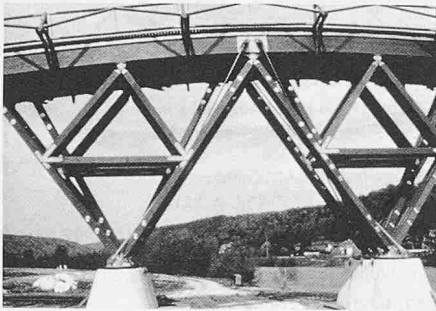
Schlanke Dreiecks-Zwischenpfeiler aus Holz auf Betonsockeln haben lediglich etwa zehn Prozent der Kräfte der knapp 200 m langen Holzbrücke zu tragen
